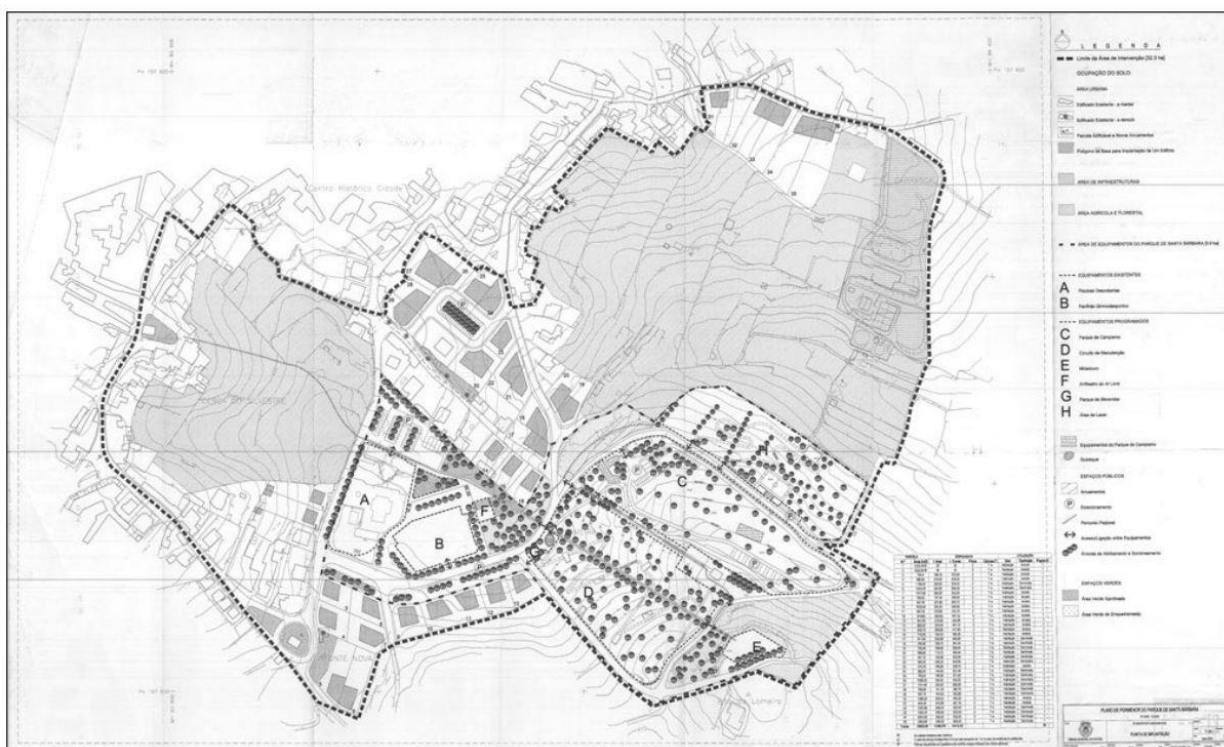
Planta de Implantação do Plano de Pormenor do Parque de Santa Bárbara (2007)
